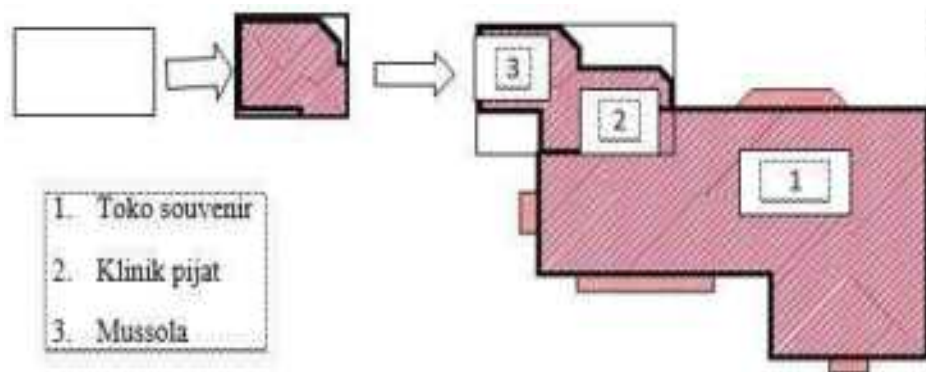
Konsep bentuk bangunan Hotel Rest area
